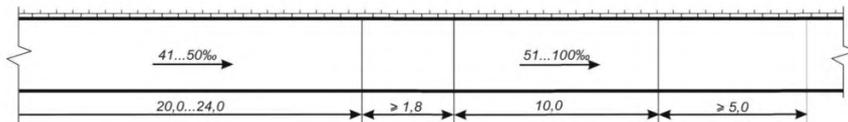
Пример планировки тротуара (пешеходной дорожки) с различными продольными уклонами
